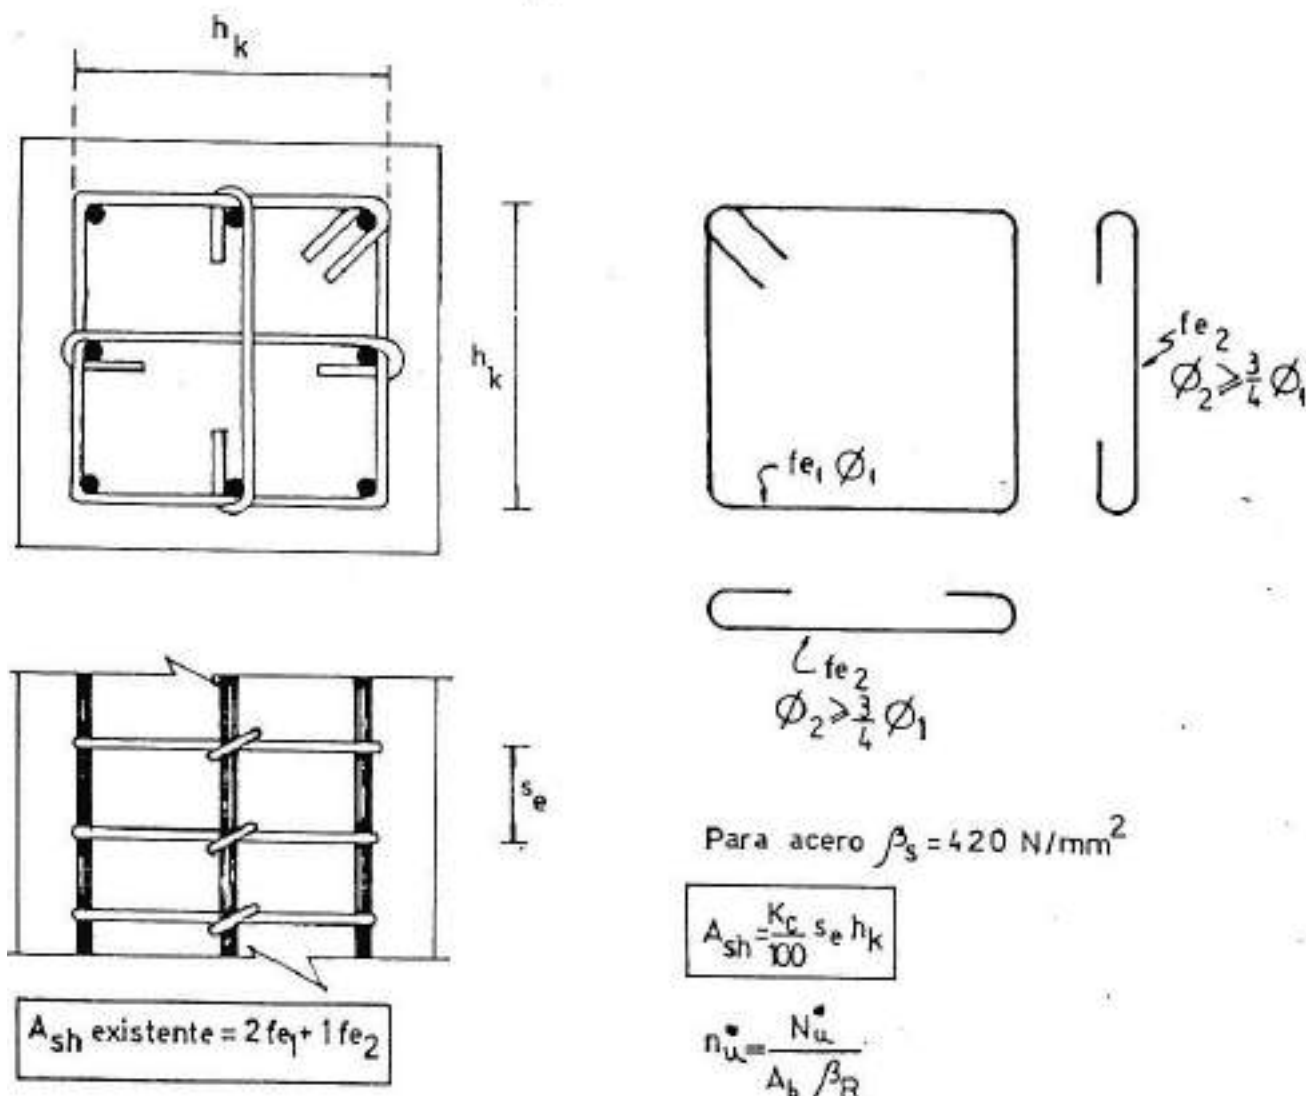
Confinamiento Extremos de ColumnasZonas a confinar
